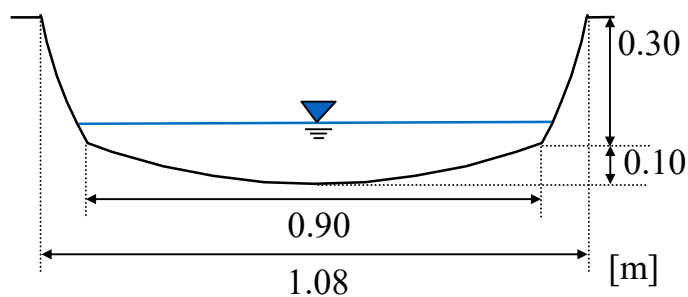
水路横断面図(施工時) ¹⁶⁾⁻¹⁸⁾
